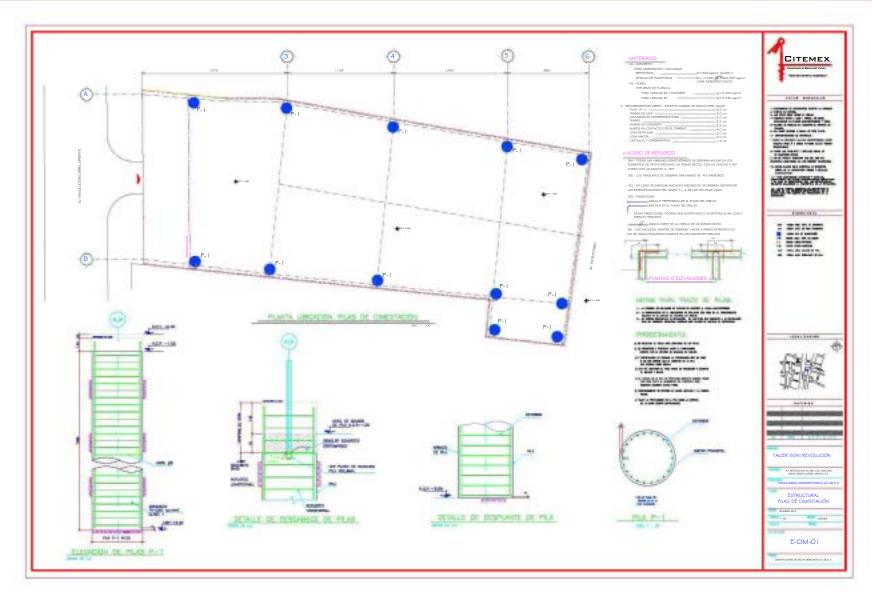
Planta con ubicación de pilas y diseño de las mismas.
